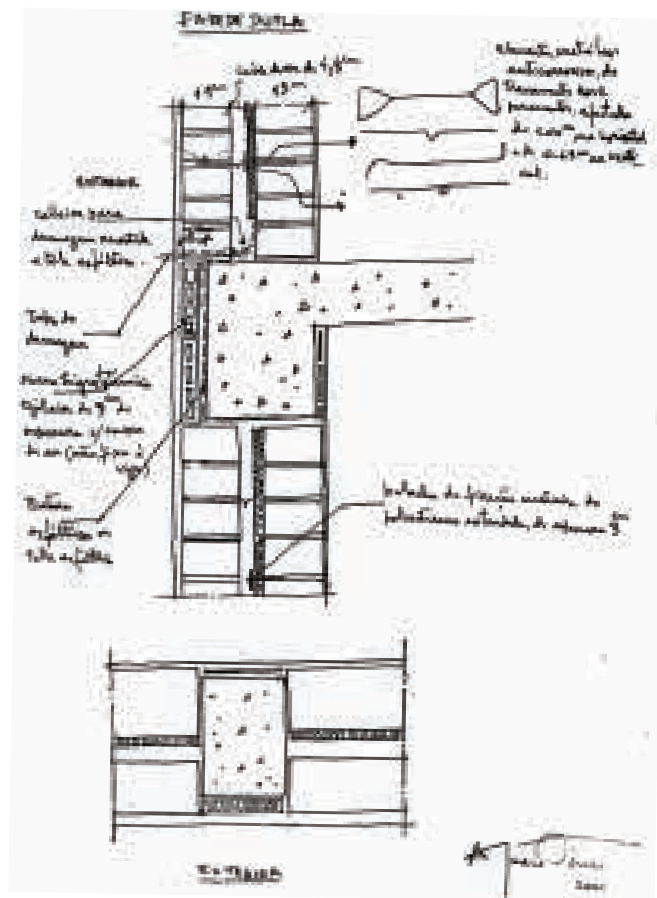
Detalhe construtivo de parede exterior de alvenaria de tijolo de duplo pano, 2000. (Pinto, 2020).
